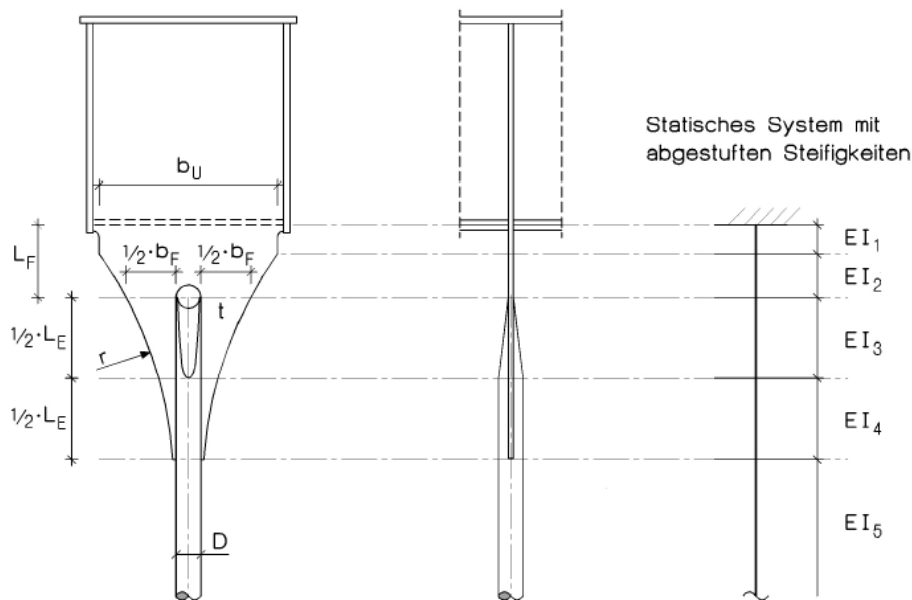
Geometrie des geschweißten Hängeranschlussbleches [2]
